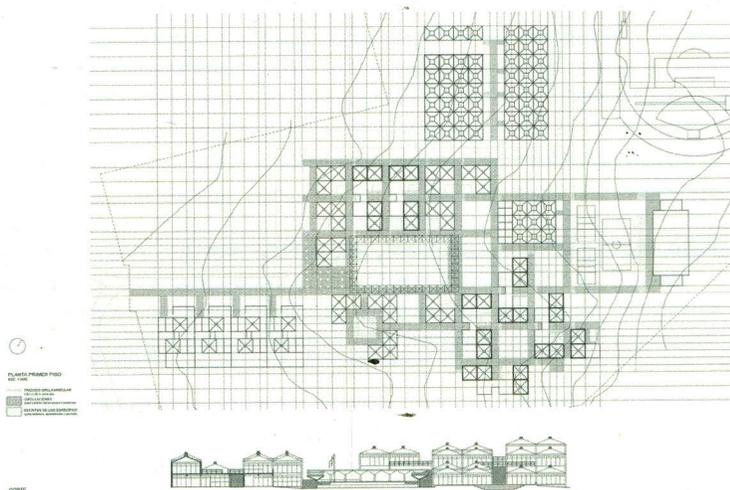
Planta y corte de la Escuela Industrial de Recursos del Mar. Fuente: dibujo de la autora a partir de planimetrías originales (Archivo del Instituto del Mar Carlos Condell, Iquique).
